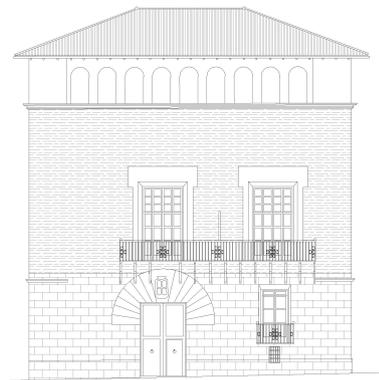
Imagen del estado de la fachada principal previo a la restauración
